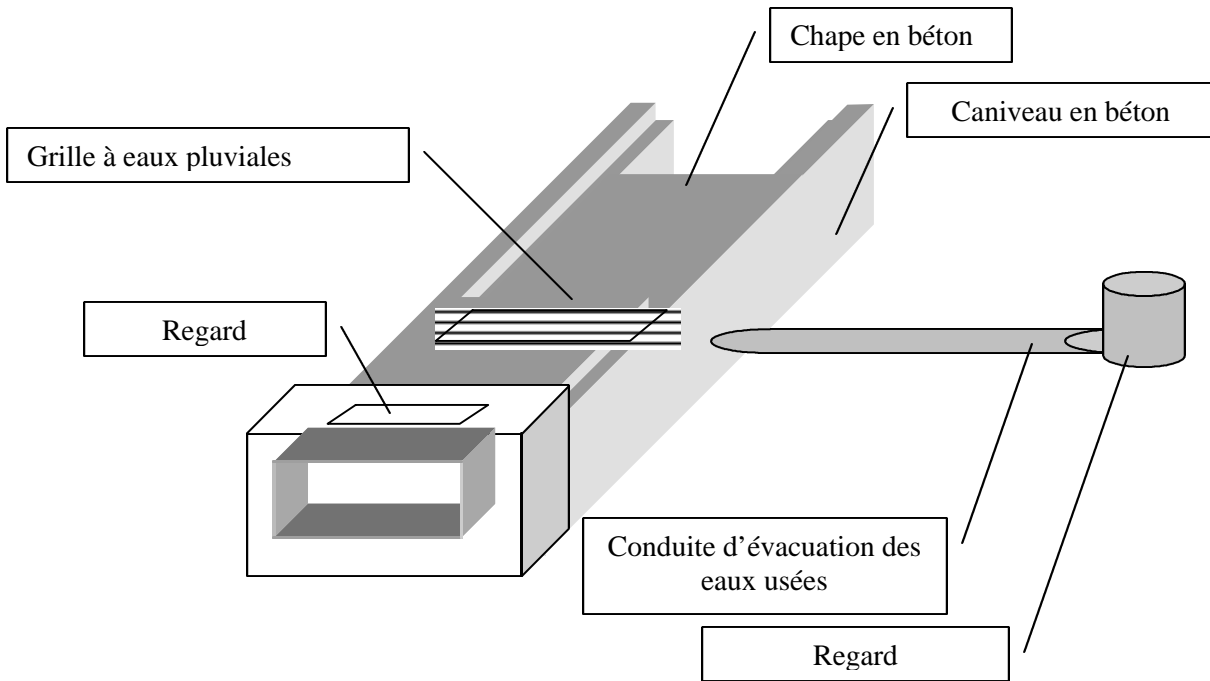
SCHEMA DES INSTALLATIONS DE COLLECTE DES EAUX USEES
